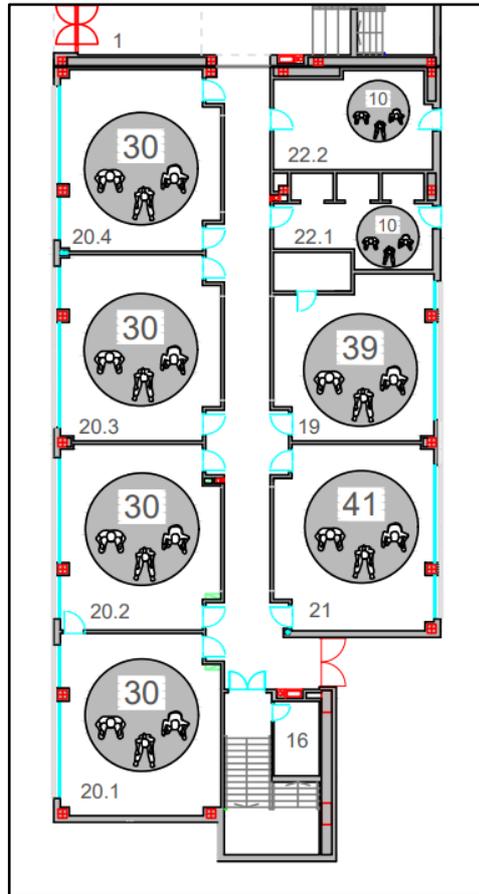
Plano con ocupación por aula de la planta baja - mitad inferior
